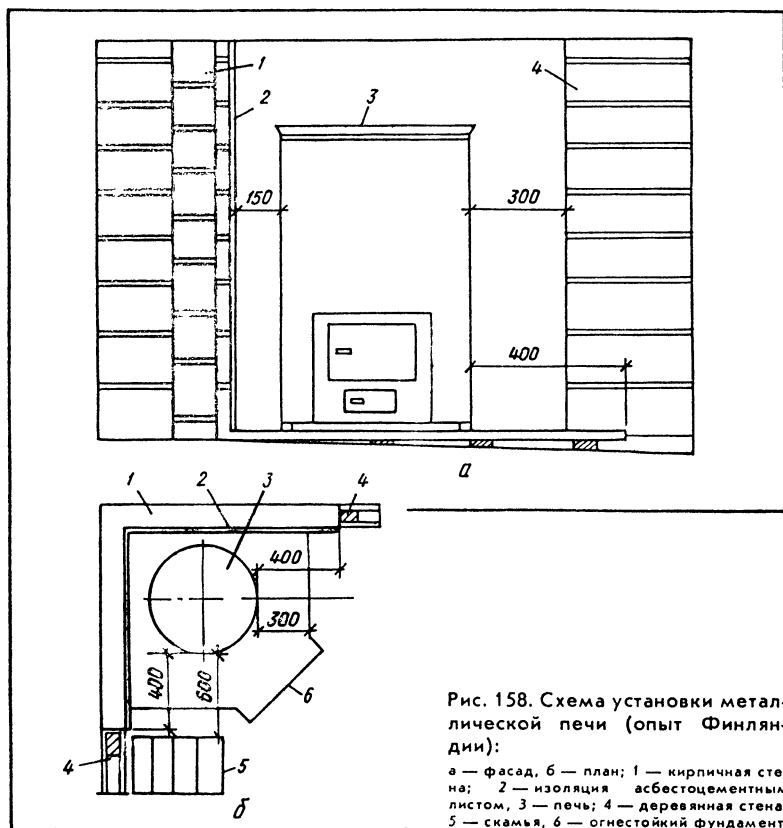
Схема установки металлической печи (опыт Финляндии):
